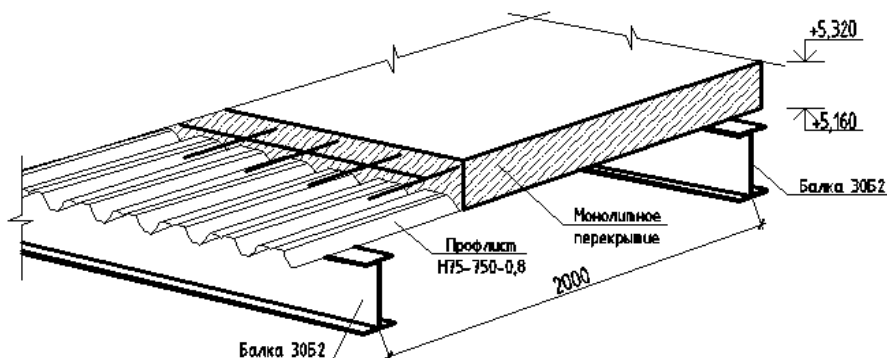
Конструкция перекрытия по профнастилу
